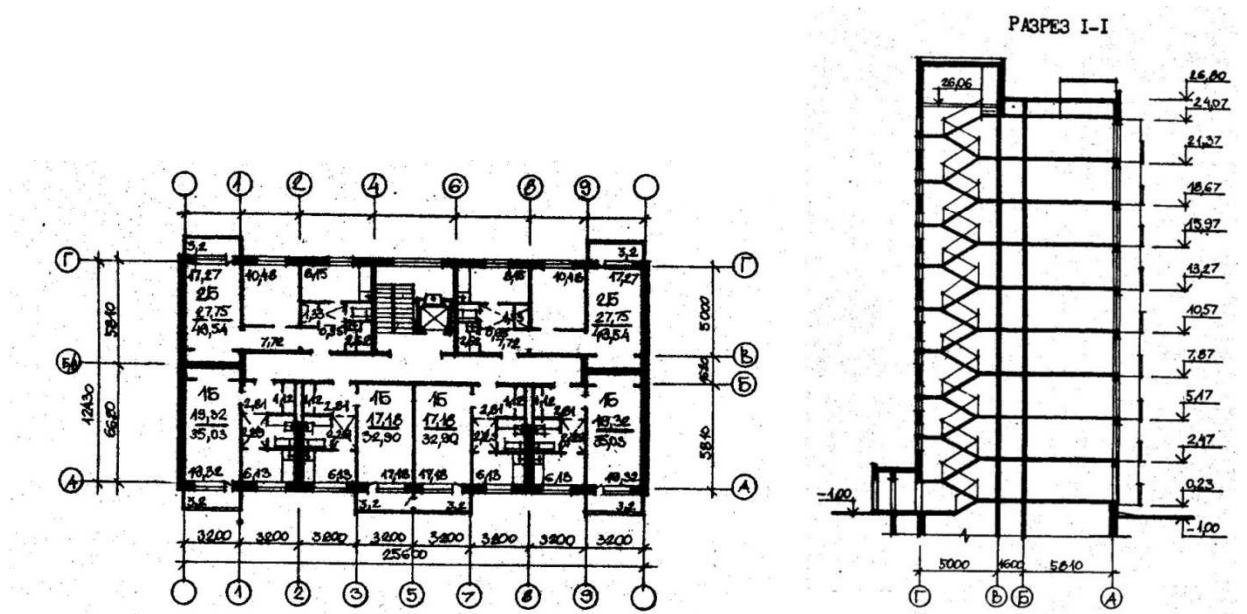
План типового поверху та переріз будівлі серії 1-480
